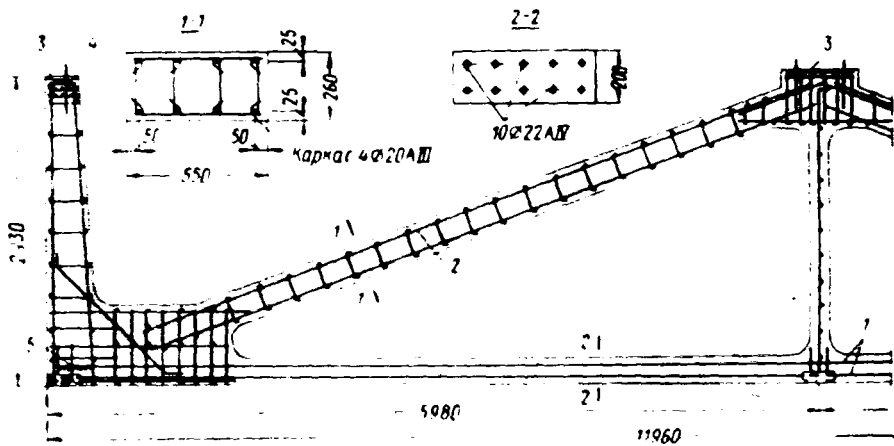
Подстропильная ферма, использованная для производственных зданий в Москве
